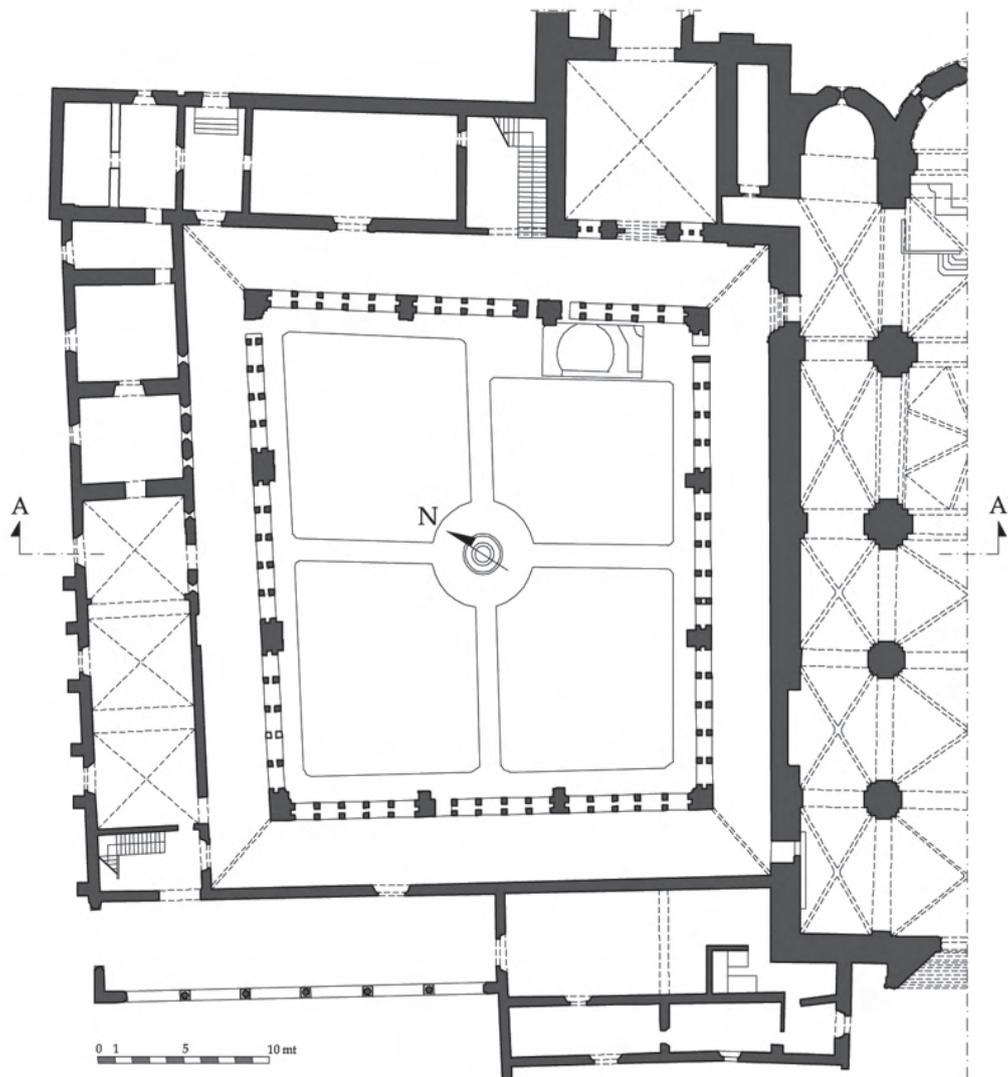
Stralcio planimetrico. La pianta del chiostro risulta stirata a nord-est per inglobare il muro *in opus incertum* del IX sec. Nella galleria di ponente si sono trovati resti di un muro dell'XI secolo, mentre in quella di levante, una porzione di parete forse del IX, in cui sono state aperte bifore e vano d'ingresso alla sala capitolare, entrambi dell'XIII.
